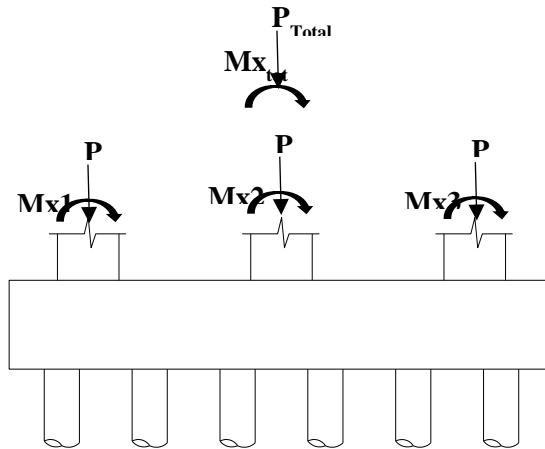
Eksentrisitas Pondasi Gabungan Arah X
